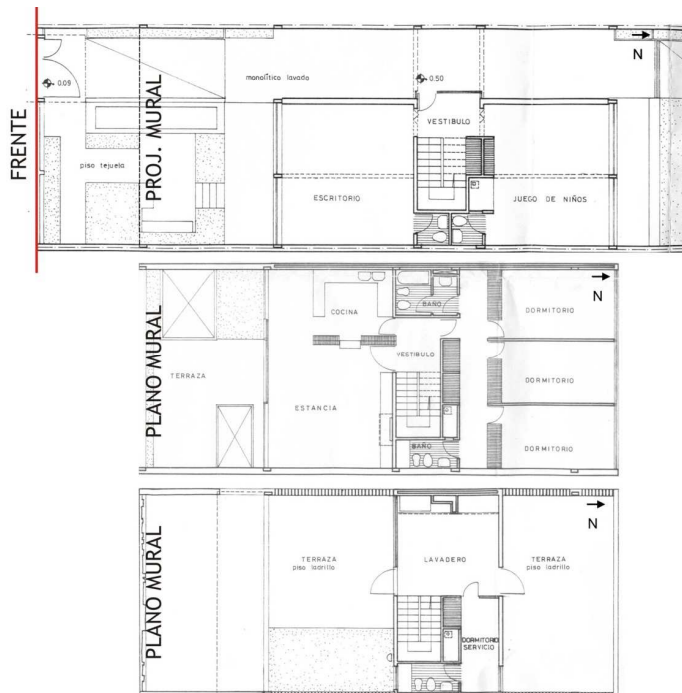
De cima para baixo: Plantas baixas dos pavimentos térreo, segundo e terceiro da Casa Gimeno. Fonte: ELARQA nº 16. Montevideu: Dos Puntos. Dezembro de 1995. p. 38.
